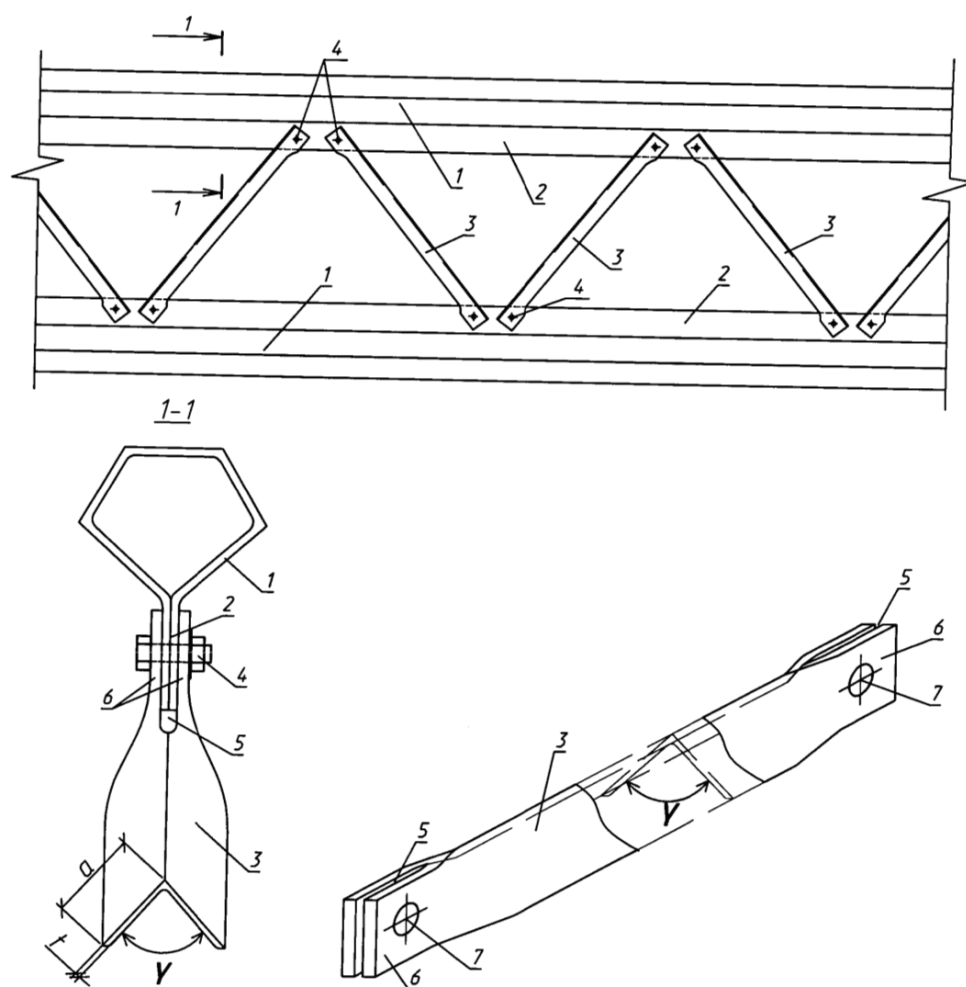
Схемы решетчатой (ферменной) конструкции: 1 – пояс из замкнутого профиля; 2 – листовая фасонка на всю длину пояса; 3 – стержень решетки из уголка; 4 – болт; 5 – прорезь; 6 – сплюснутые полки стержня решетки; 7 – отверстие
